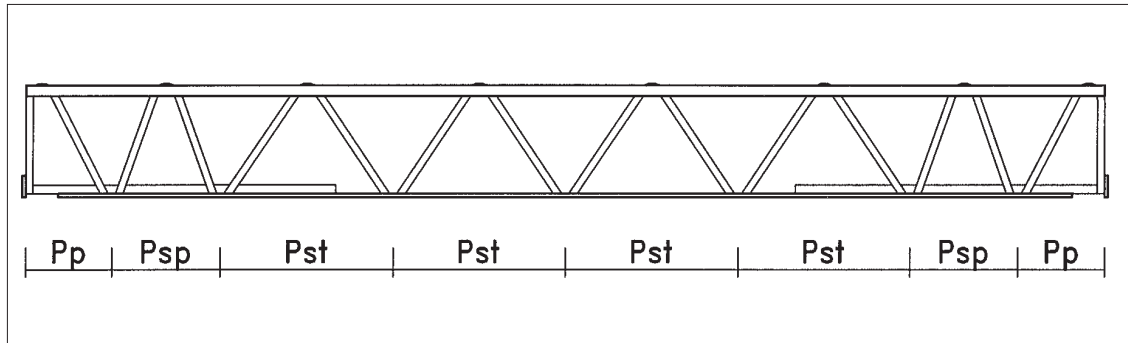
Disposizione passi trave con fondello in acciaio.
